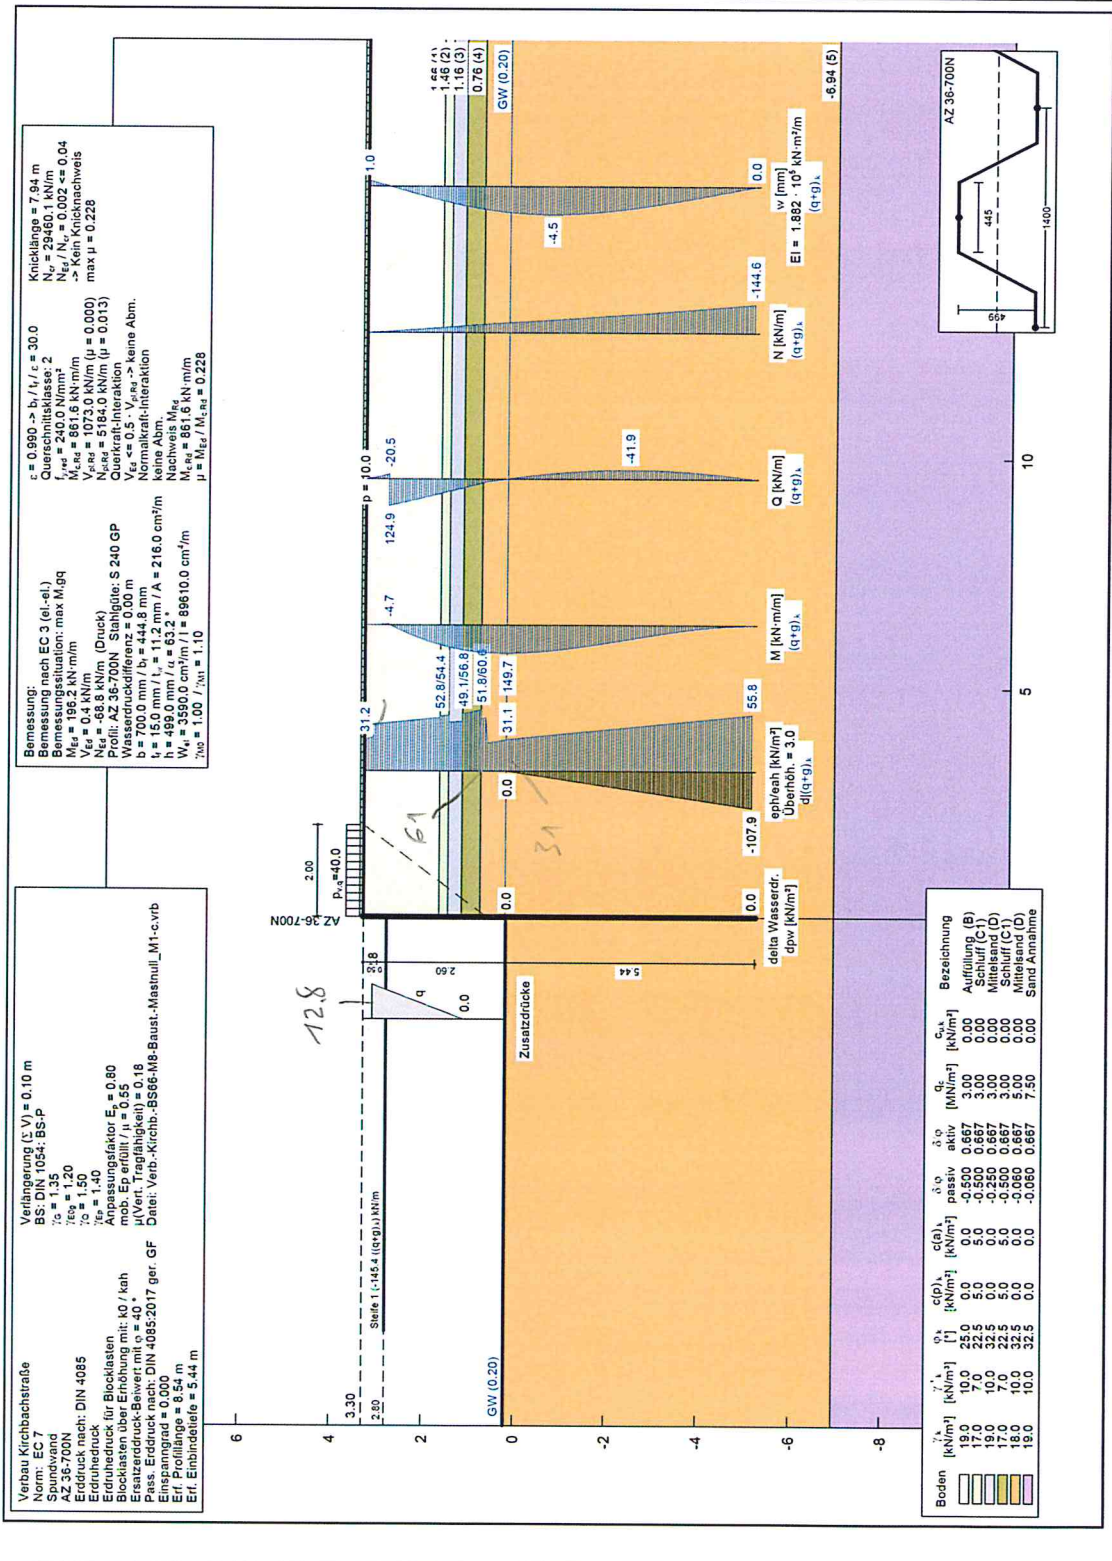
d Erddrücke -Im Bereich Mast M8-BS66 (Längs und Querverbau) d) Mit Baustellenlasten+Mastnull_M2
